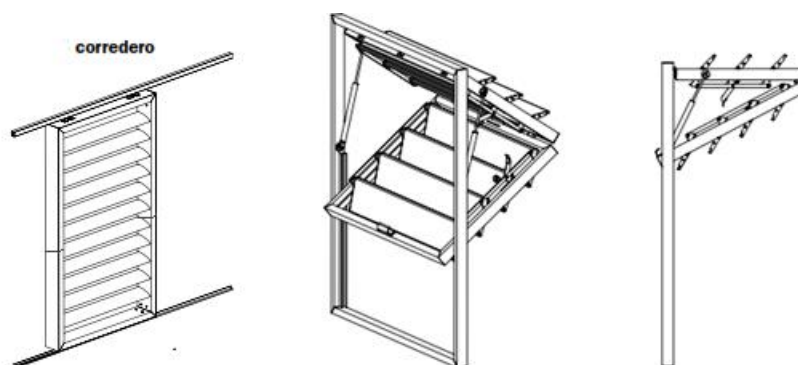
Sistemas de protección solar exterior en huecos de fachada.
